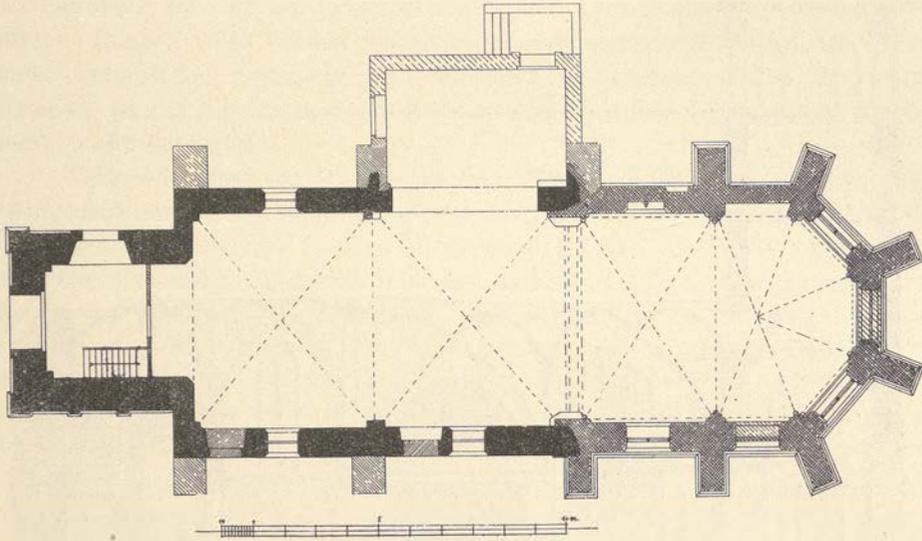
Baerl. Evangelische Pfarrkirche. Grundriss.
